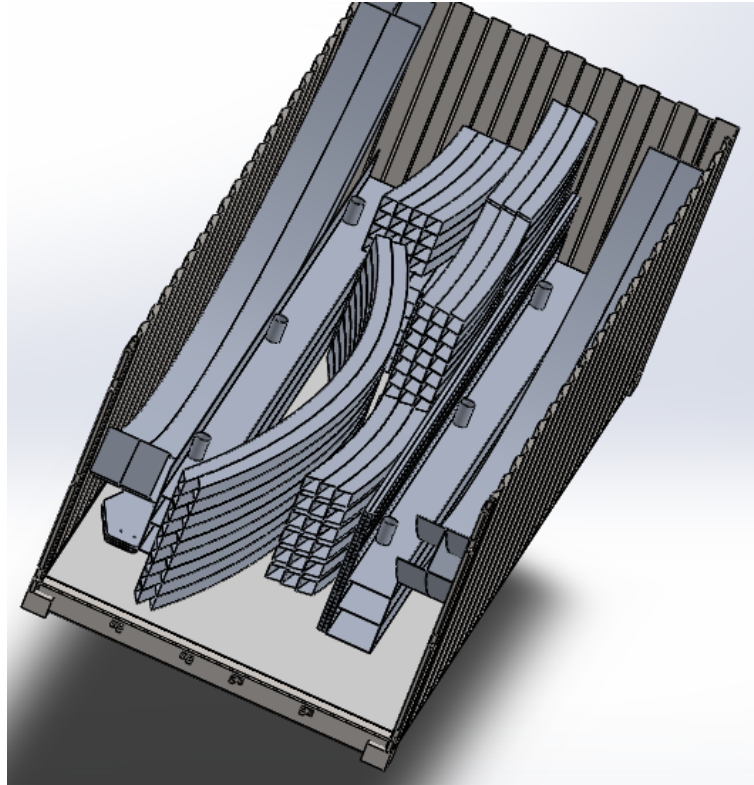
Vista superiore del container caricato con gli elementi della struttura
